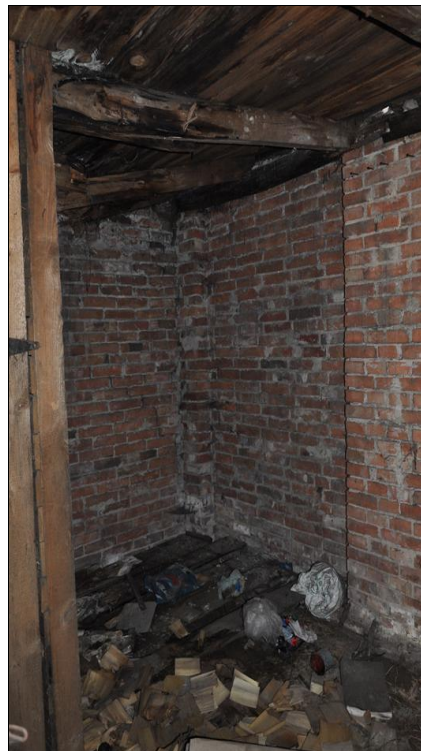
Wnętrze komórki z uszkodzoną konstrukcją dachu.
